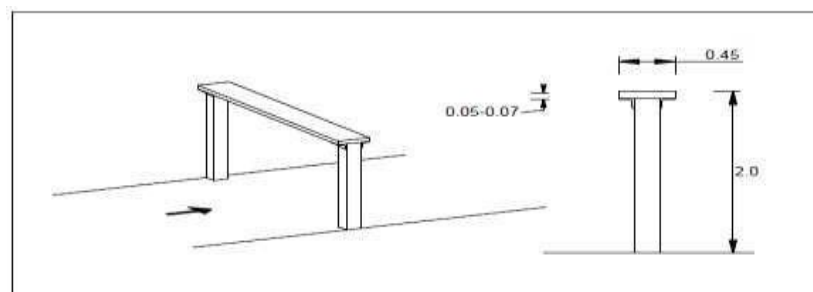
Vigas Horizontais- Máximo e Mínimo
